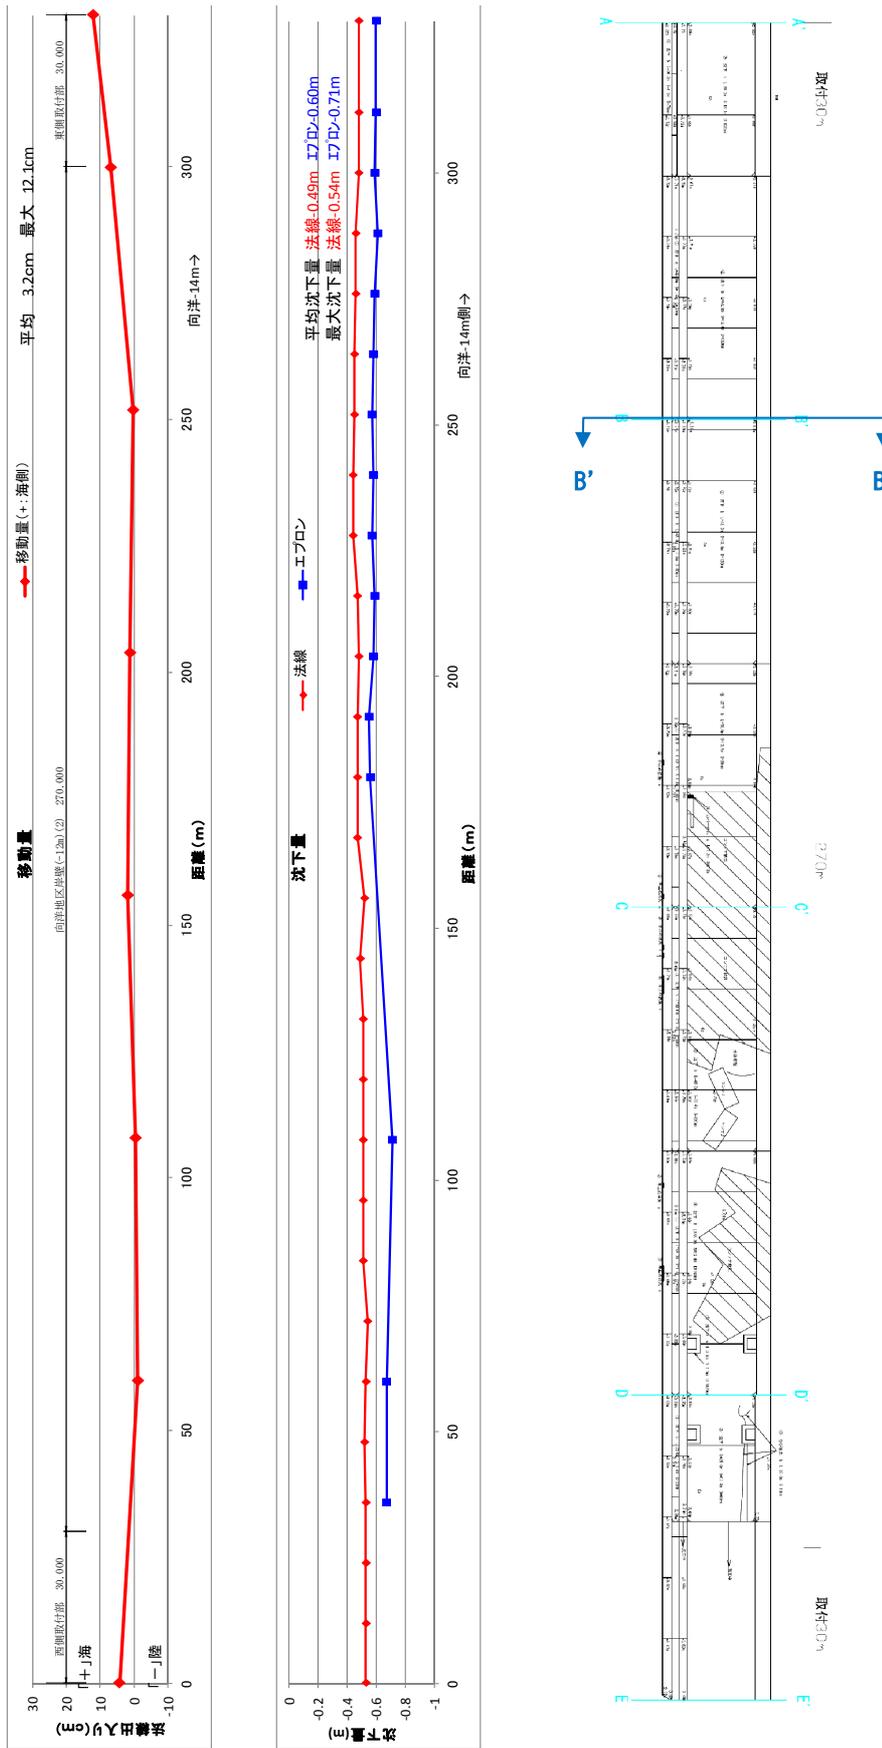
仙台港区\_中野地区\_岸壁 (-12m) の平面図, 沈下・移動量 (被災後)
